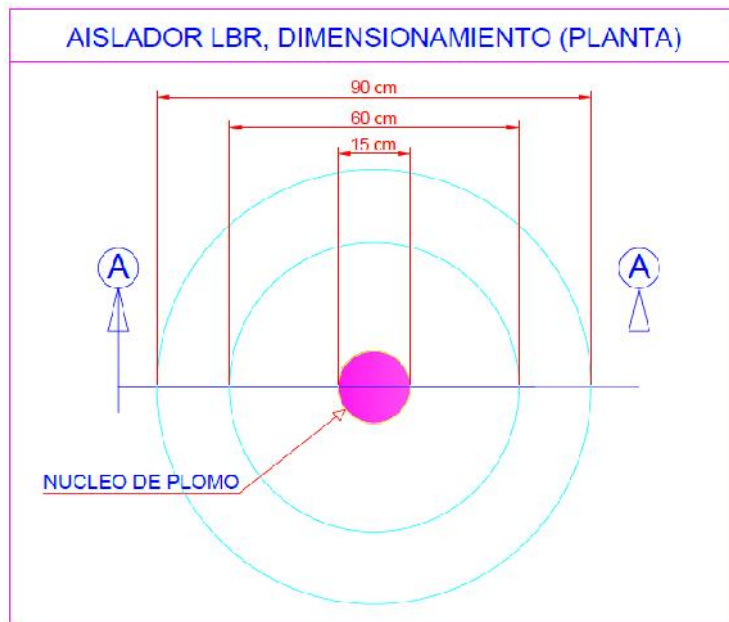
Aislador LBR, Dimensionamiento planta
